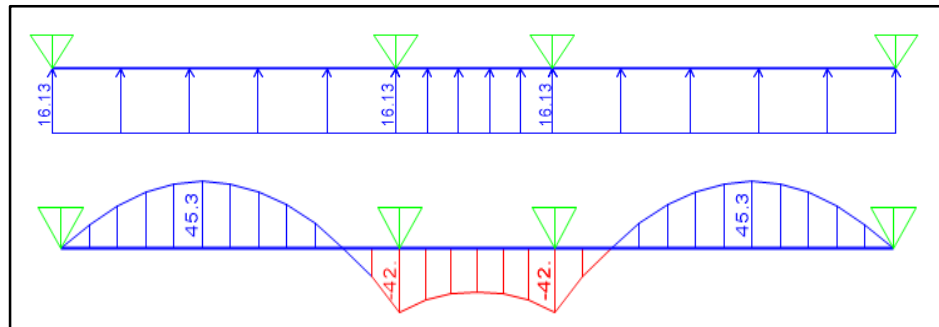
DMF de la viga - Zapata reticular con viga de cimentación - Sistema dual tipo II
